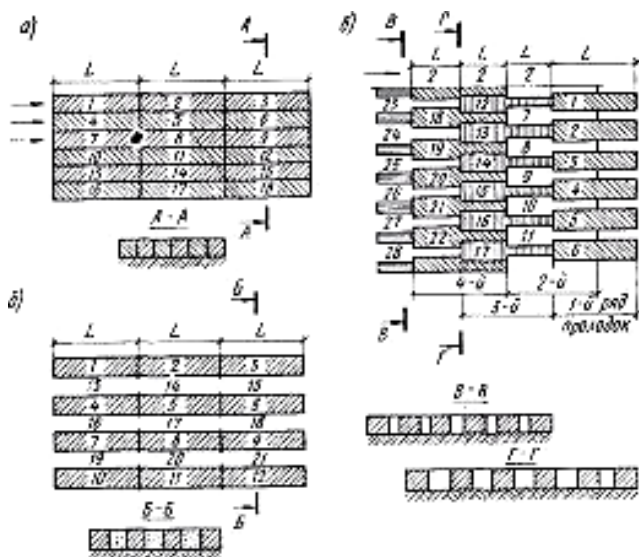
Планировка площадок скреперами: а — разработка грунта по схеме «полоса рядом с полосой»; б — то же, через полосу; в - то же, ребристо-шахматными проходками; 1—28 — проходки.
